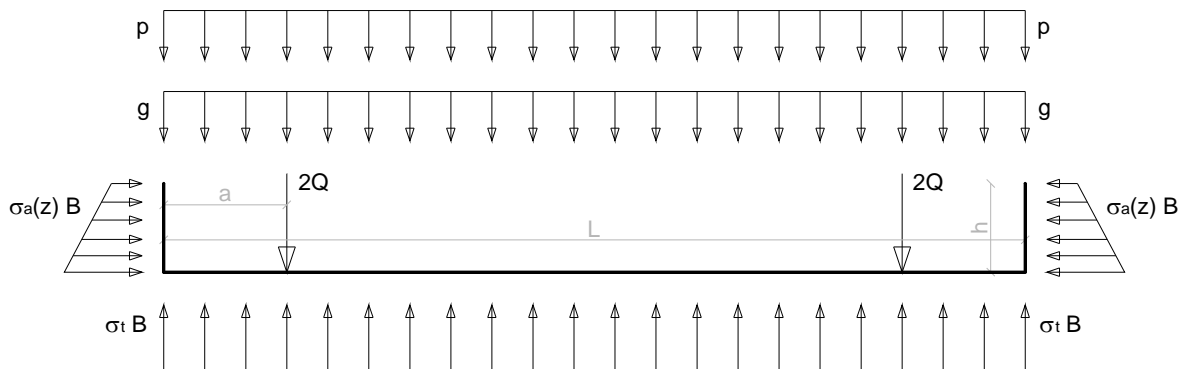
Schema strutturale a trave con indicazione dei carichi agenti.
